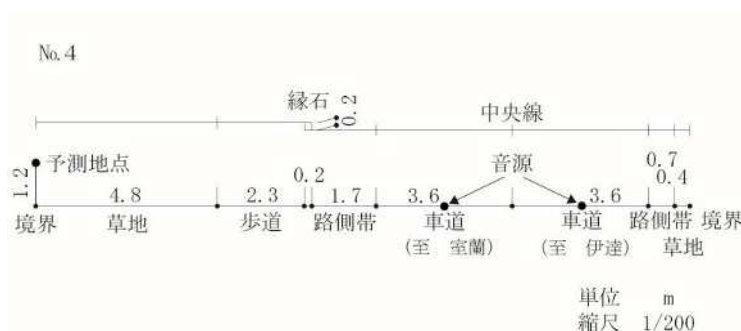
(2) 予測対象道路の断面図 (No. 4)
